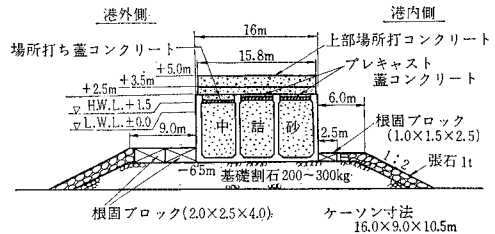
八戸港北防波堤断面図 (1968 年度より) 単位: m
